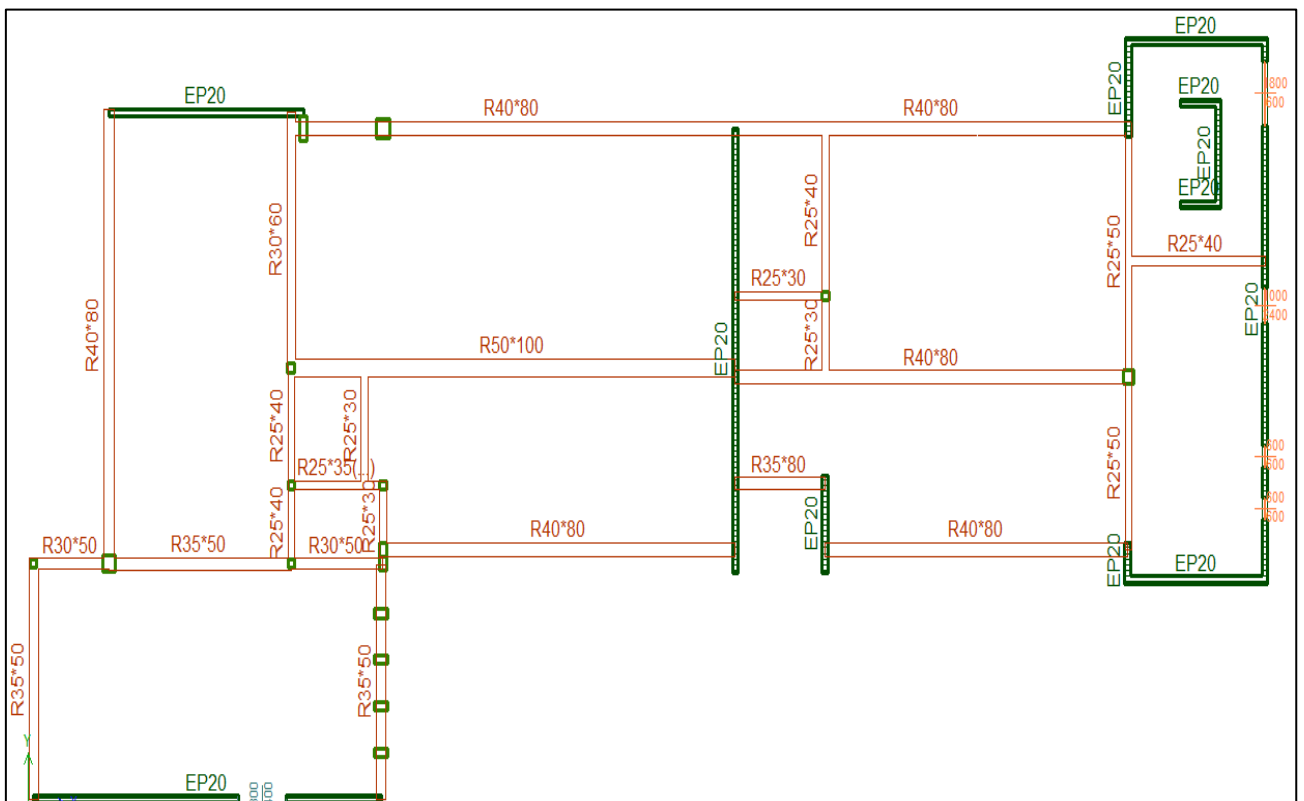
Pré-dimensionnement des voiles et poutres RDC, Tranche 2
